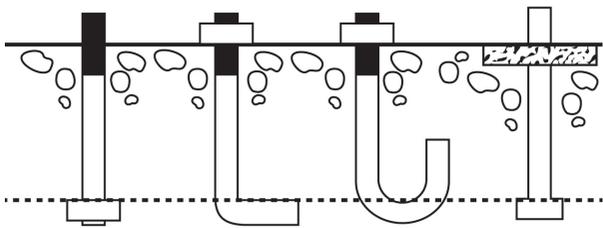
Anclajes preinstalados. Fuente ACI 2008.
